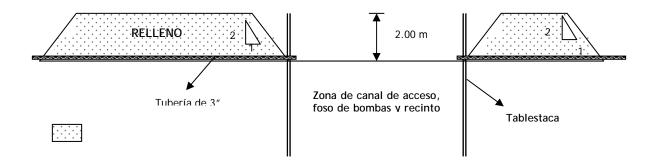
Detalle de las Zonas que deben Rellenarse - Corte 1-1-Perfil
